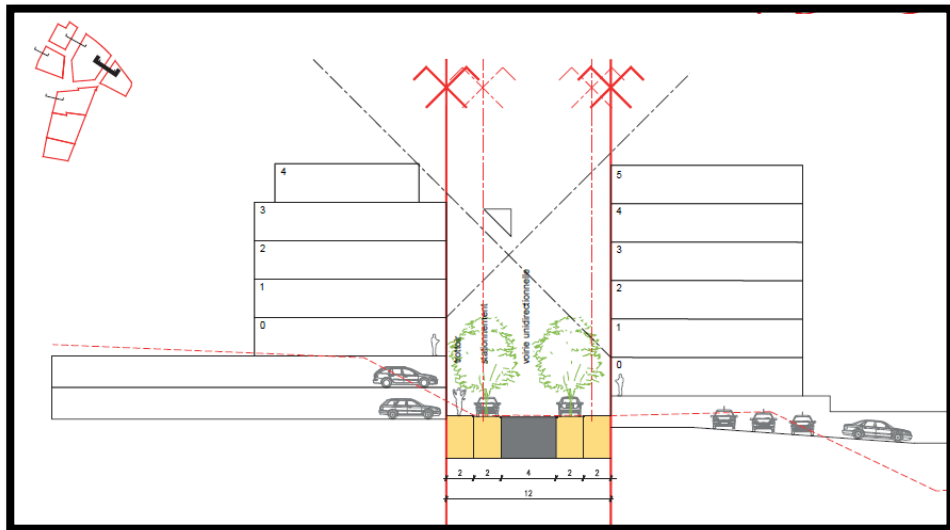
Extraits des plans de coupes (source Maître d'Ouvrage)
